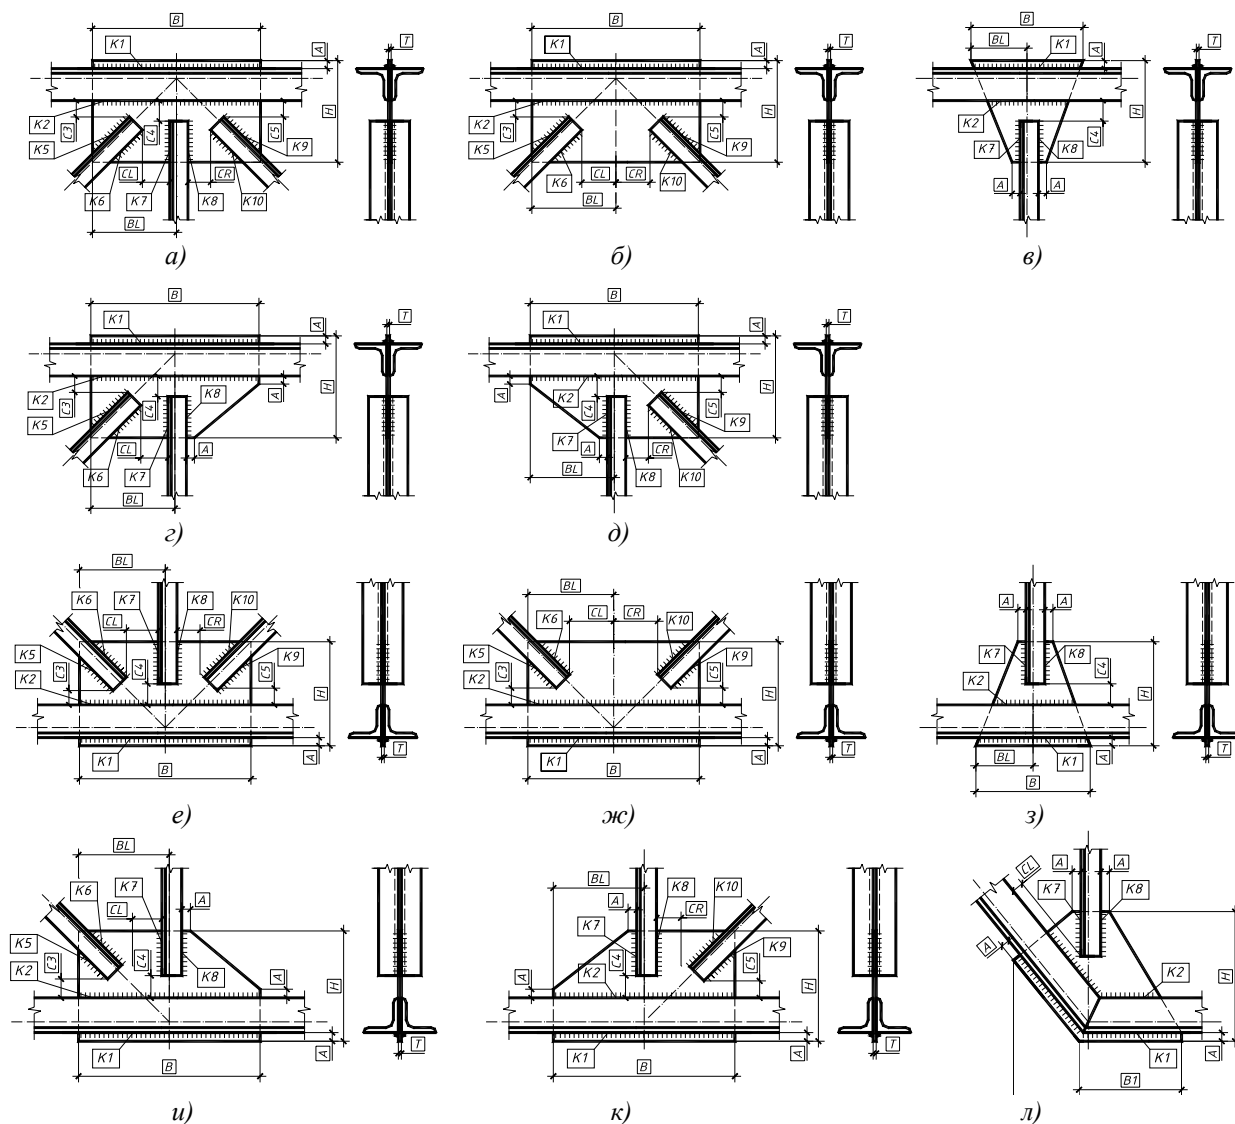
Рядовые узлы ферм из спаренных уголков
